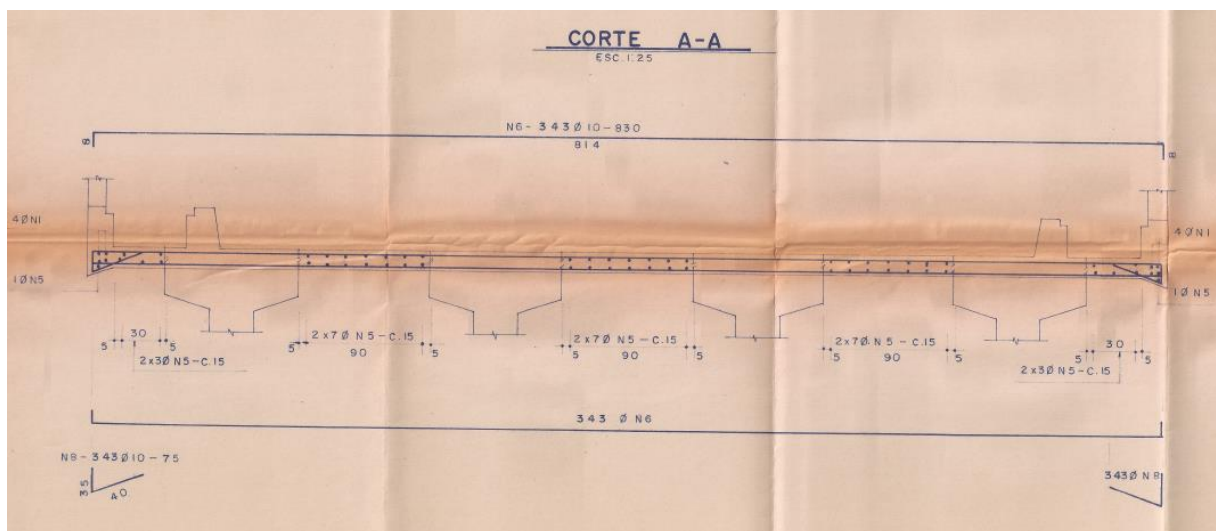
Seção do Tabuleiro – Ponte de Acesso – Lajes com armaduras expostas
